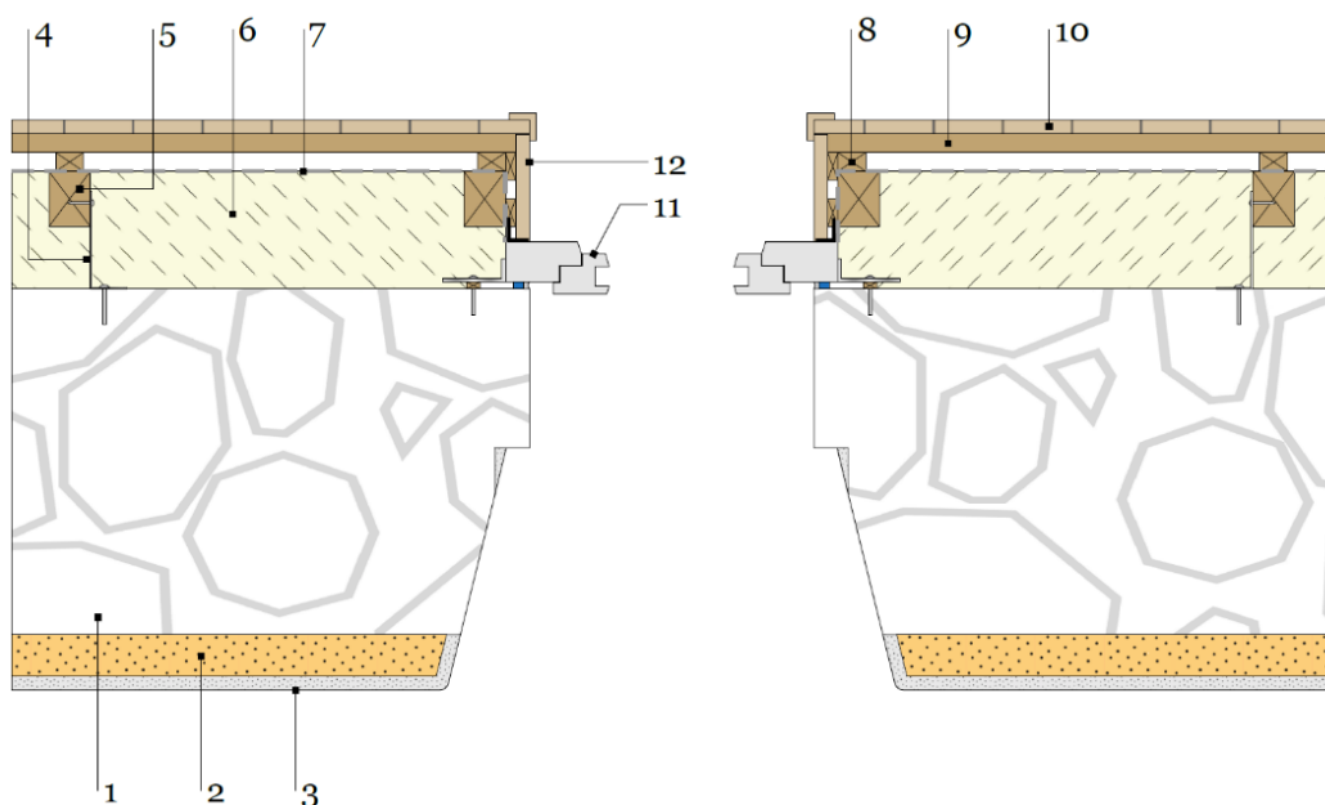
Coupe horizontale et coupe verticale de la jonction ITI de mur FH15 / menuiserie avec la pose de la menuiserie en tunnel du côté intérieur
